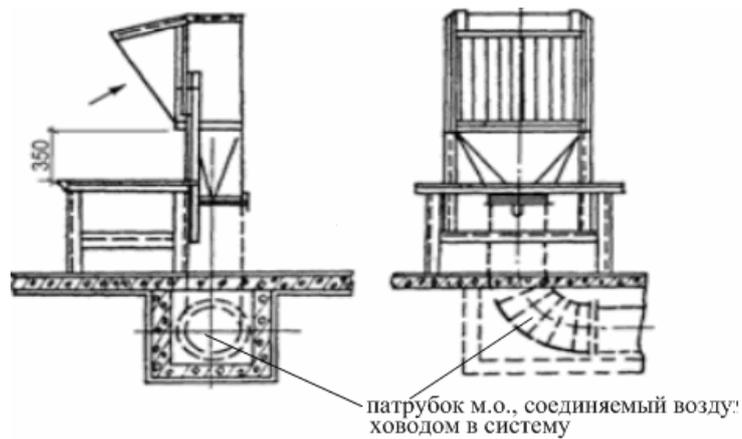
Устройство отсасывающей панели Чернобережского над сварочным столом с нижним отводом газа
